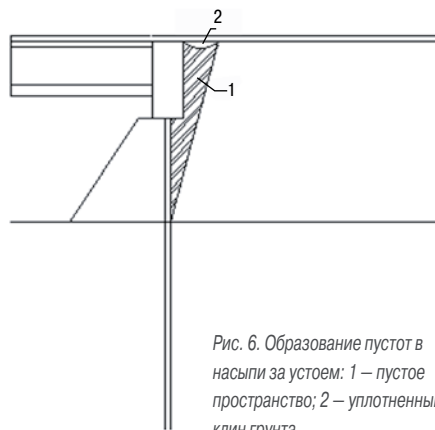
Образование пустот в насыпи за устоем: 1 – пустое пространство; 2 – уплотненный клин грунта
